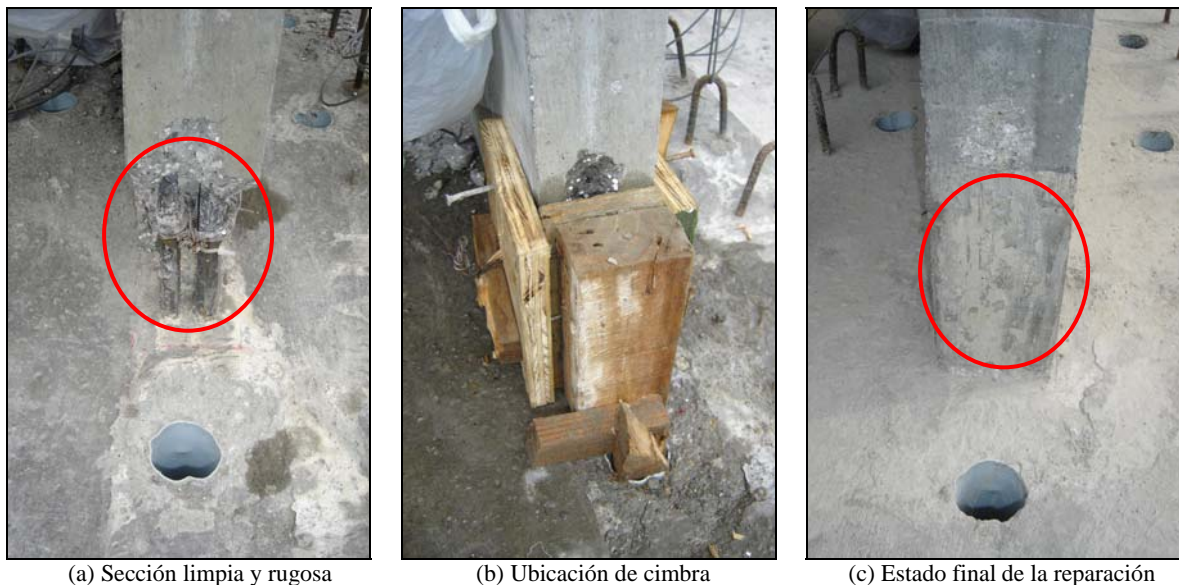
Reparación de elemento de borde en muro cuadrado con concreto de peso ligero
